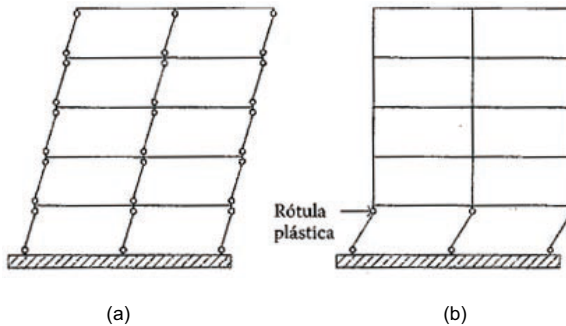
Estructura del tipo viga fuerte-columna débil. (a) Plastificación en todas las plantas. (b) Plastificación sólo en la planta baja (Fuente: Benavent-Climent, 2010)
